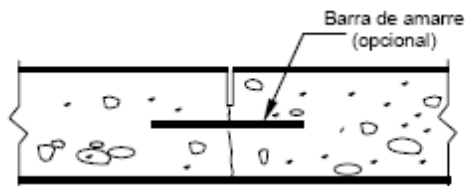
Junta longitudinal de construcción con barras de amarre.
